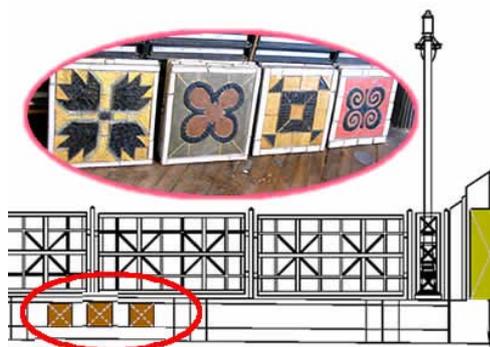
Decoração mural da fachada de um prédio em Gana com aplicação de adinkras
